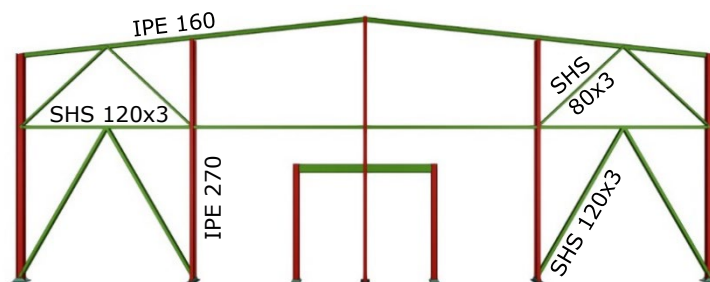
M. Pórtico de fachada frontal de la nave 1.
